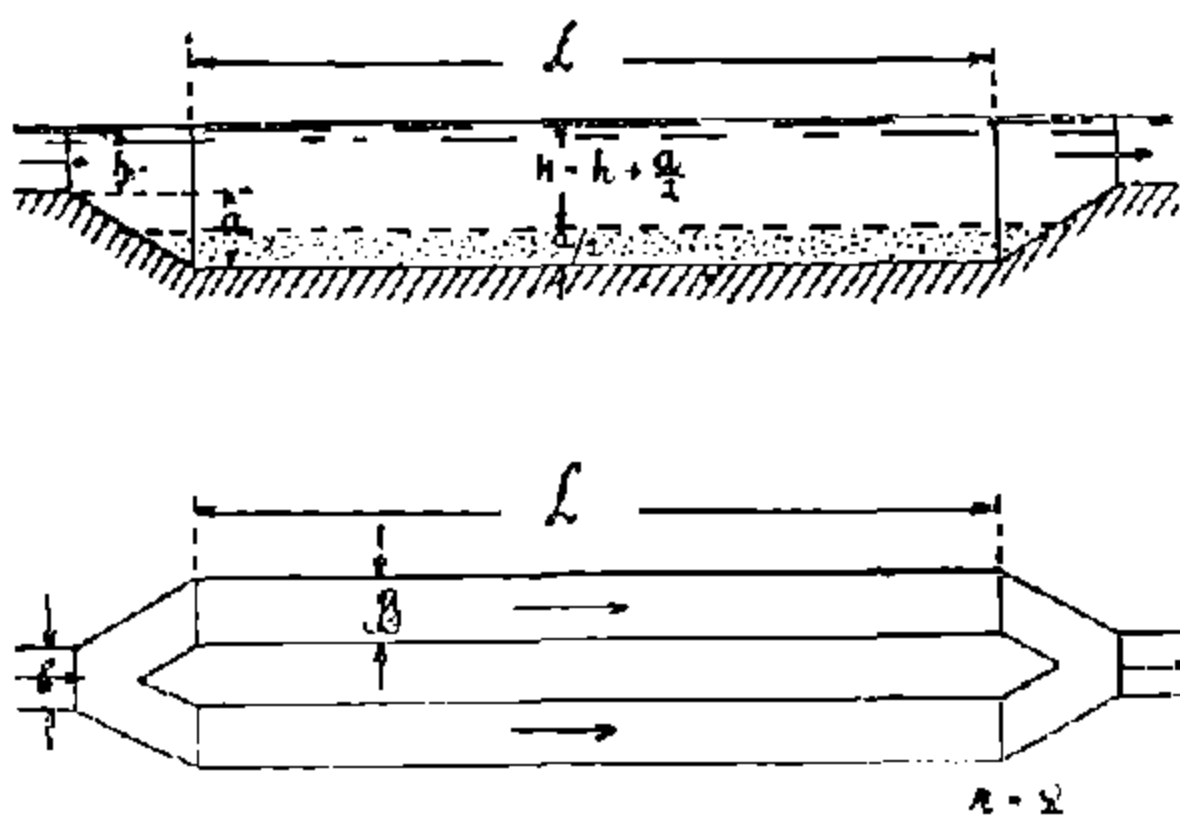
Схема горизонтальной песколовки. Продольный разрез и план.
